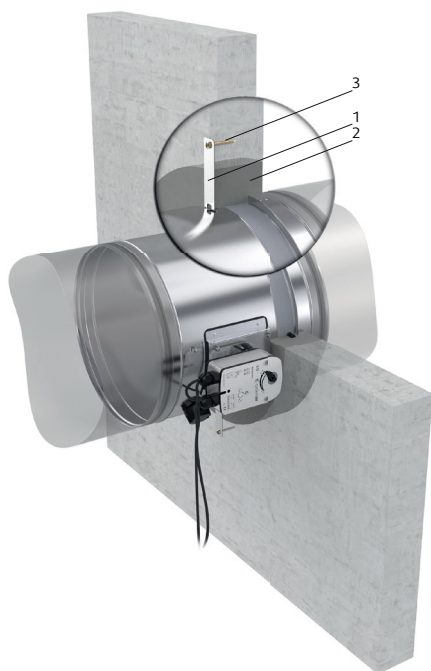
Våt installation av ett cirkulärt brand-/ brandgasspjäll PKIR med en blandning av gips och murbruk eller betong
